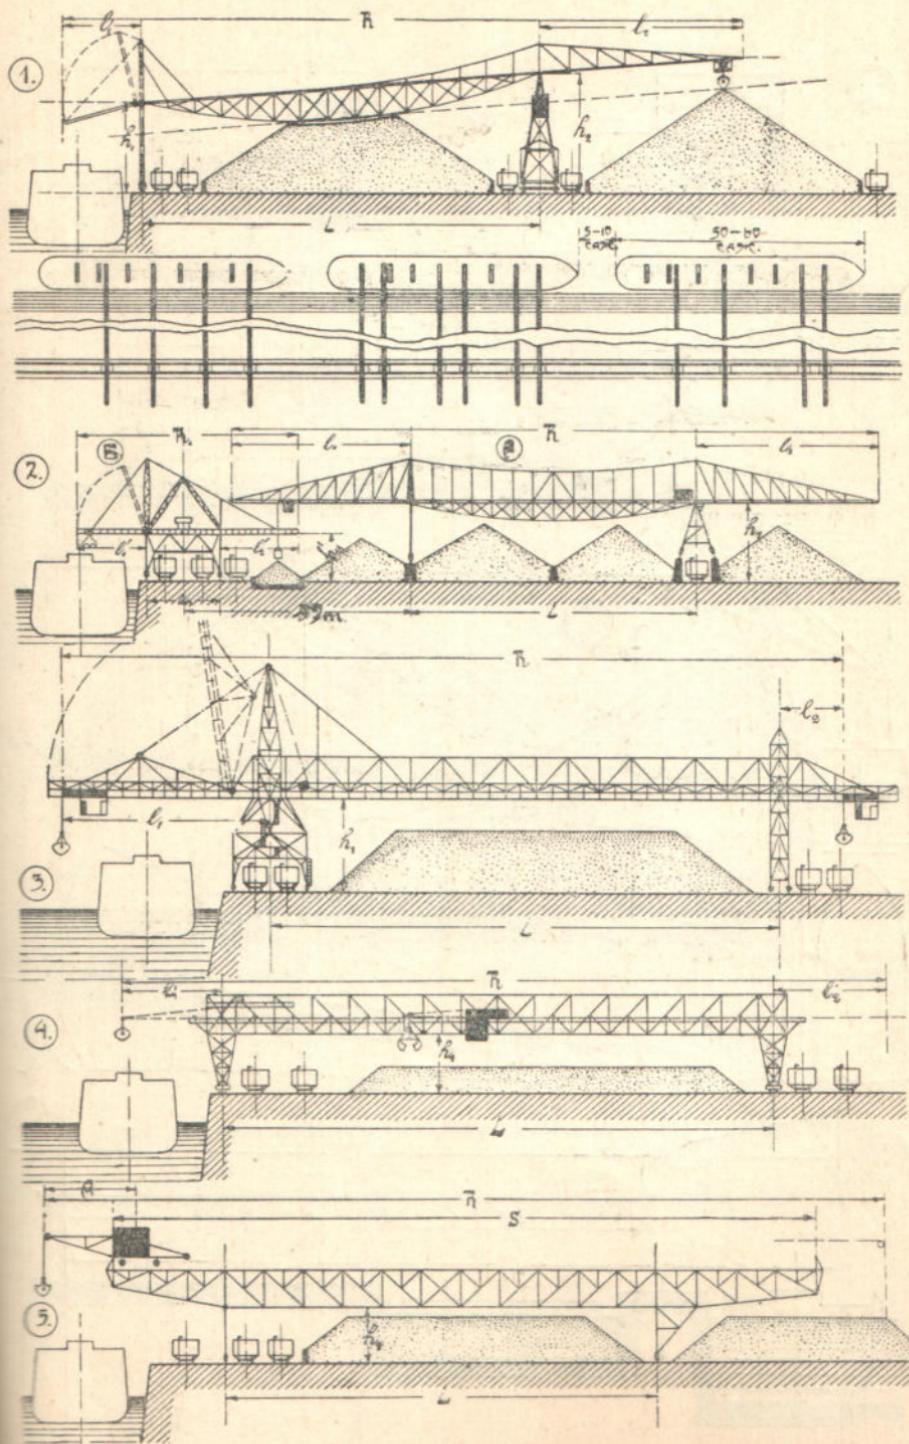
Схемы крановых установок для выгрузки угля или руды из судов на берег.
